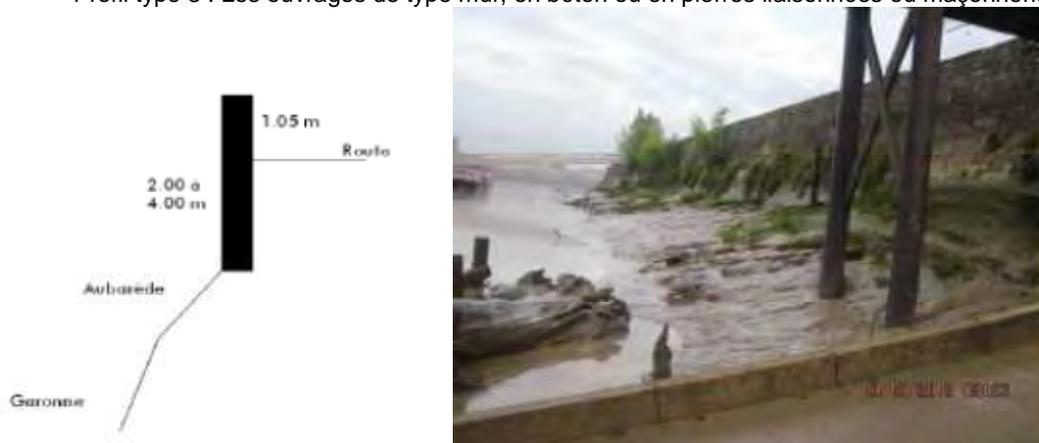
Dignes de type mur en béton ou en pierres - Source : Etude de danger des ouvrages de protection du SPIRD - 2013
